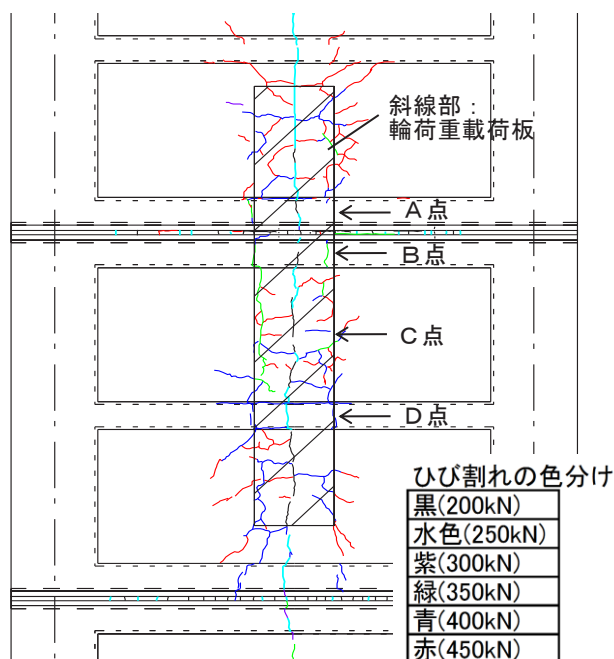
ひび割れ発生状況（累計載荷 54 万回）
